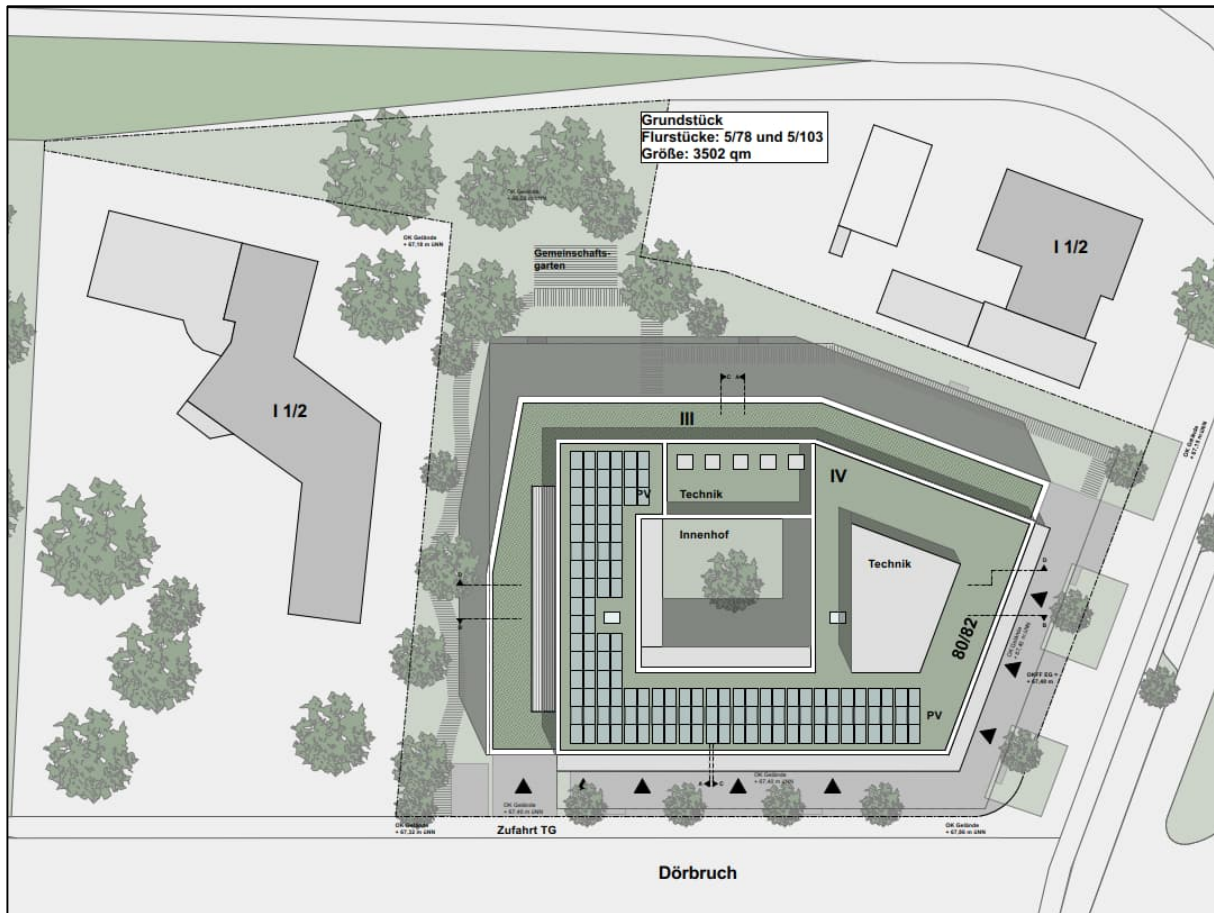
Lageplan Bebauungsentwurf (Ausschnitt ohne Maßstab, k+a architekten)
